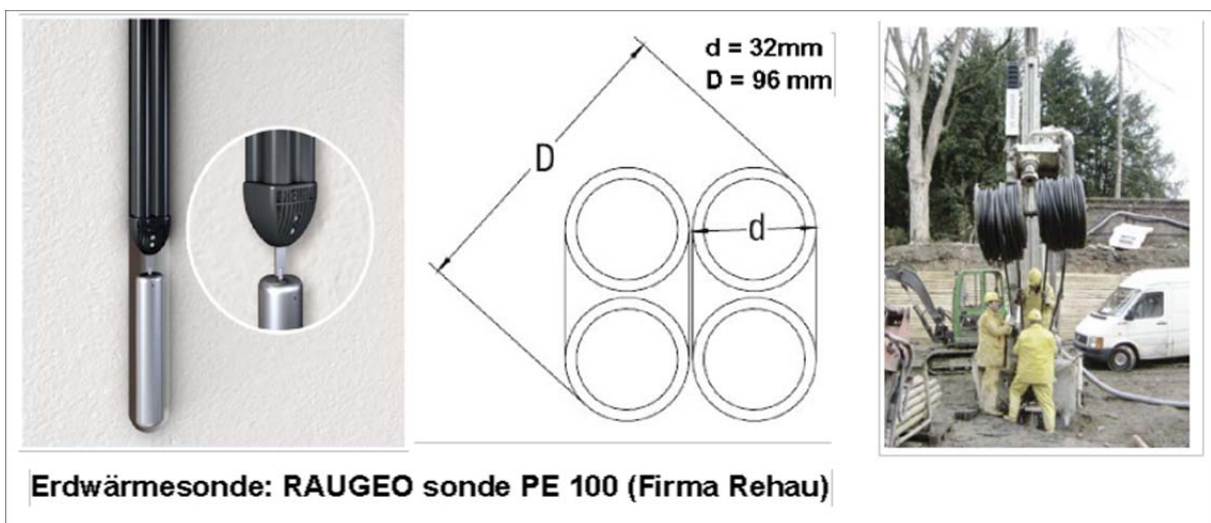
REHAU – Erdwärmesonde RAUGEO Sonde PE100 (Dimensionen, Verlegung, Einbau)
